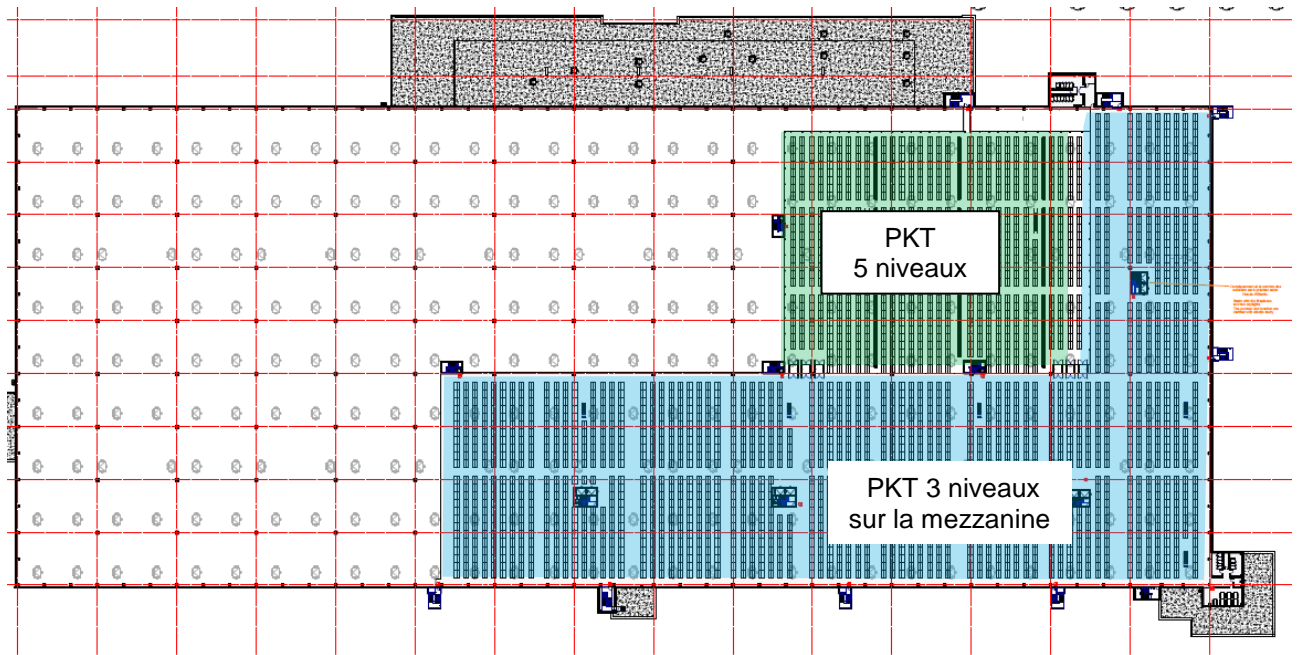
Plan du niveau sur mezzanine – P2 (+6,00 m)
